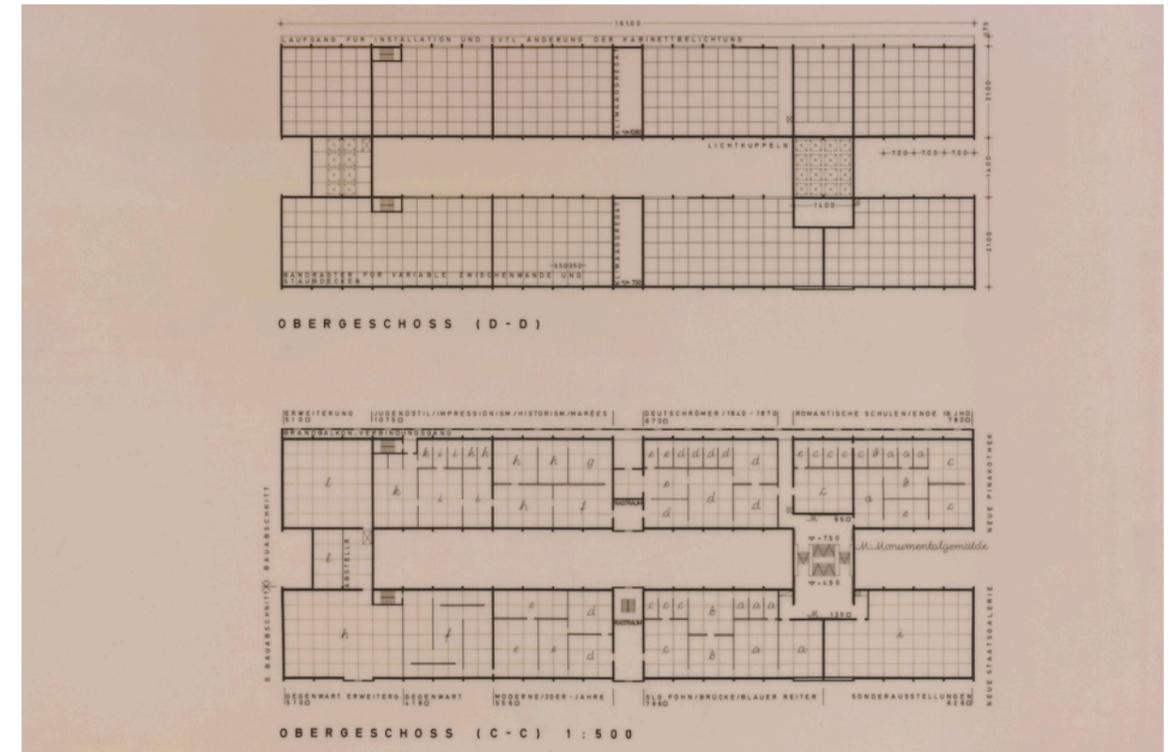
Grundrisse Obergeschoss (D-D),(C-C), Planzeichnung
